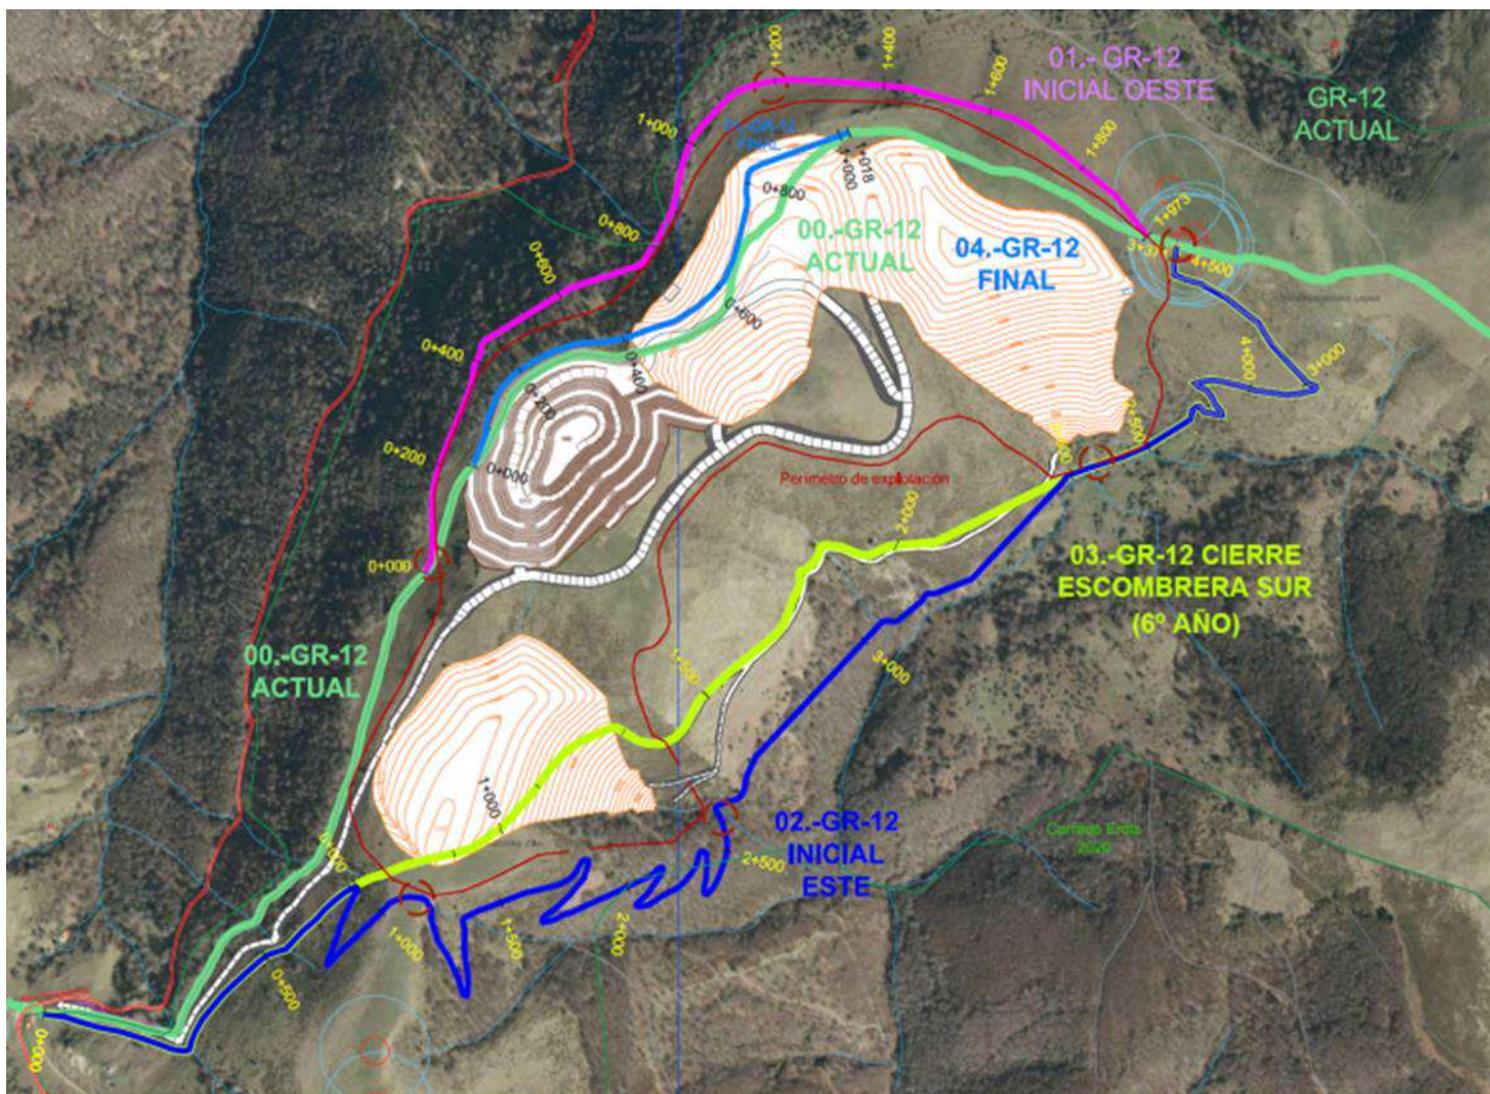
Trazados alternativos GR-12 sobre ortofoto
